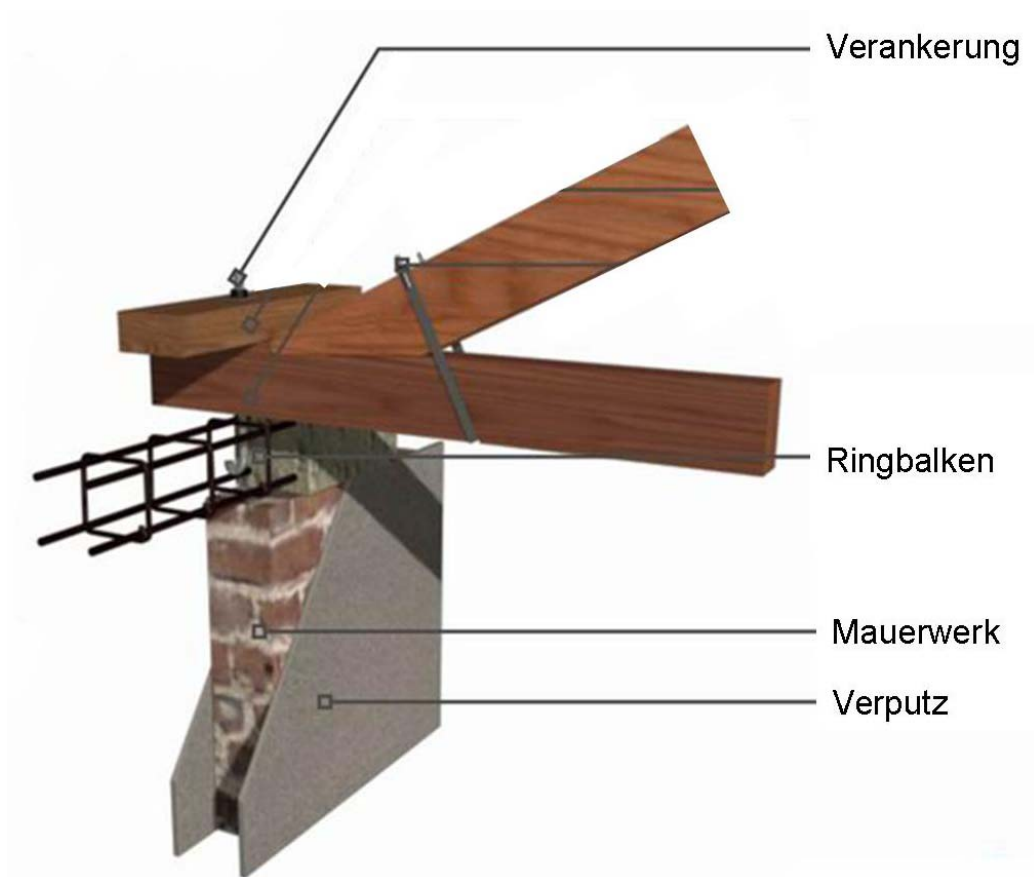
Verankerung der Dachkonstruktion (Posyanis (2006))
